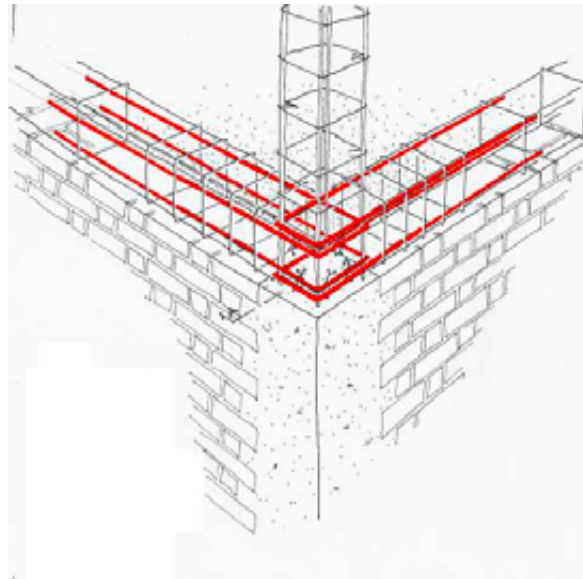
Detalle de las barras de refuerzo en el encuentro de muros en L (Schacher, 2006)
